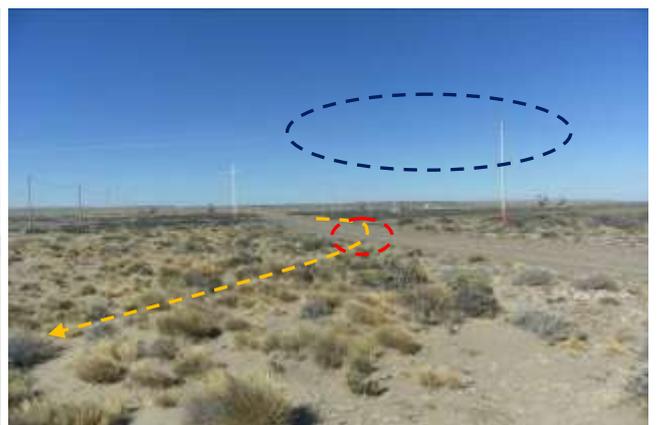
Emplazamiento de oleoducto, cambio de dirección hacia NE por picada existente. Cruce con camino (rojo) y línea eléctrica (azul). Foto en dirección SO.
